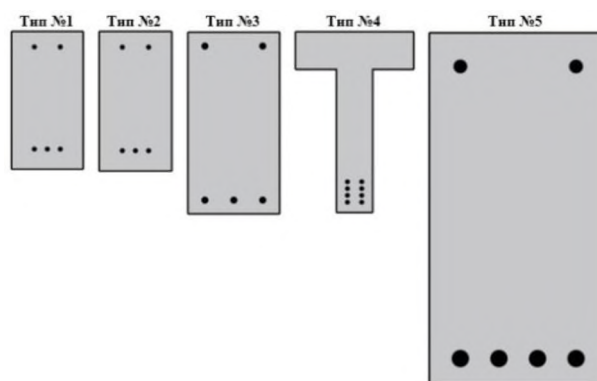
Поперечные сечения рассматриваемых типов железобетонных балок
